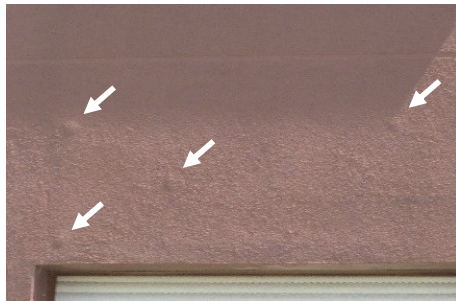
Detalle de la deformación del mortero en las zonas sobre las espigas. Fuente: Marta Epelde.
